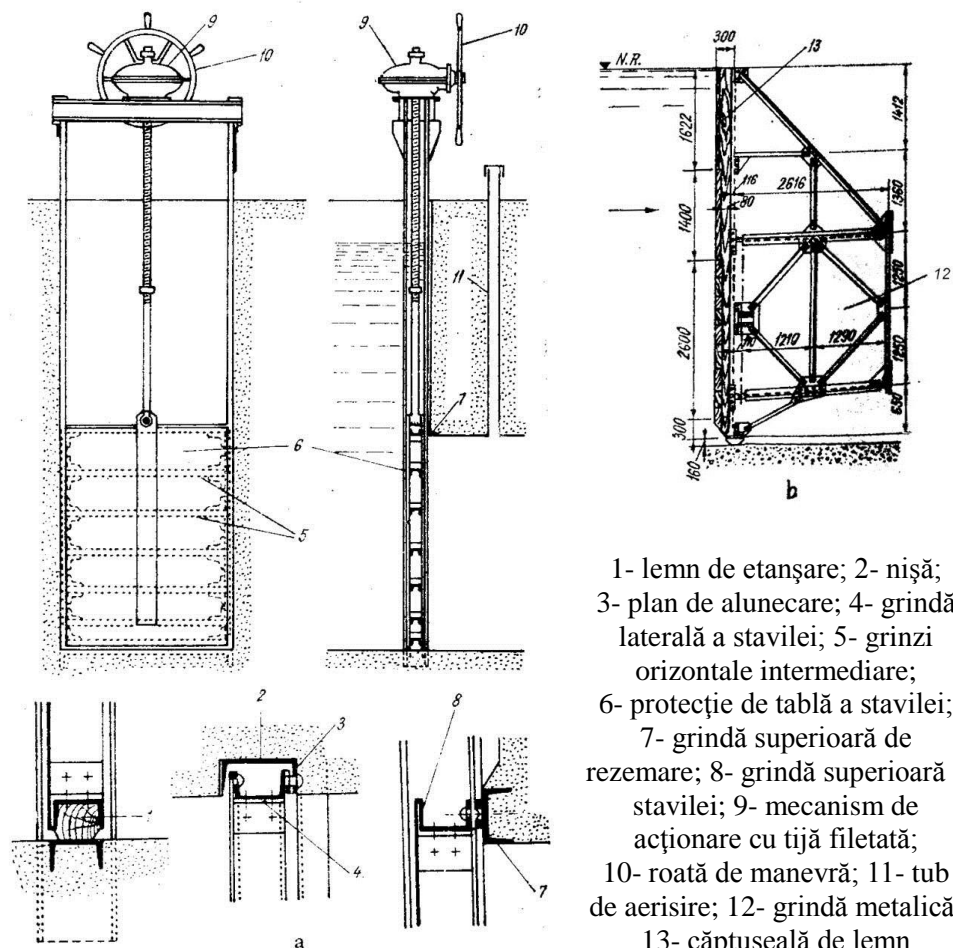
Stăvilă plană simplă. a) de lemn; b) de metal
